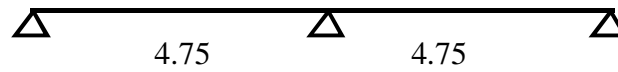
type de poutrelle (RDC-1^{er} étage)
